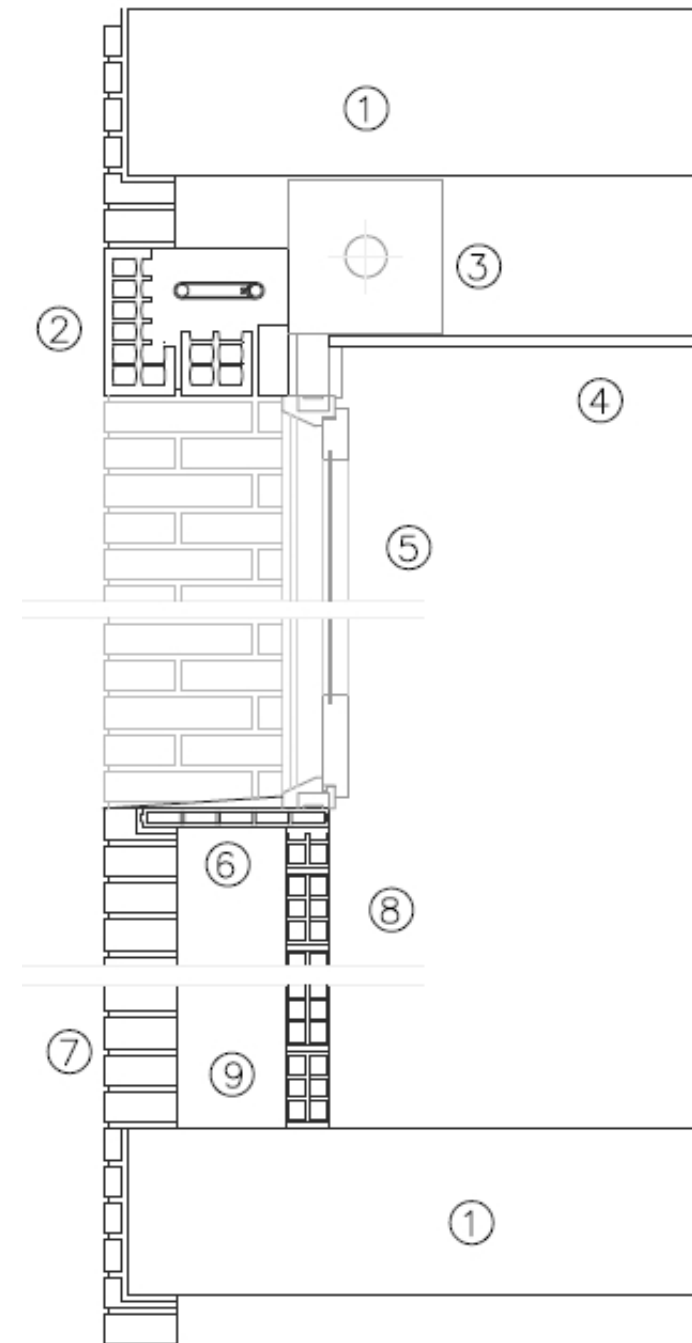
Detalle constructivo. Sección vertical de fachada por hueco. Elaboración propia
